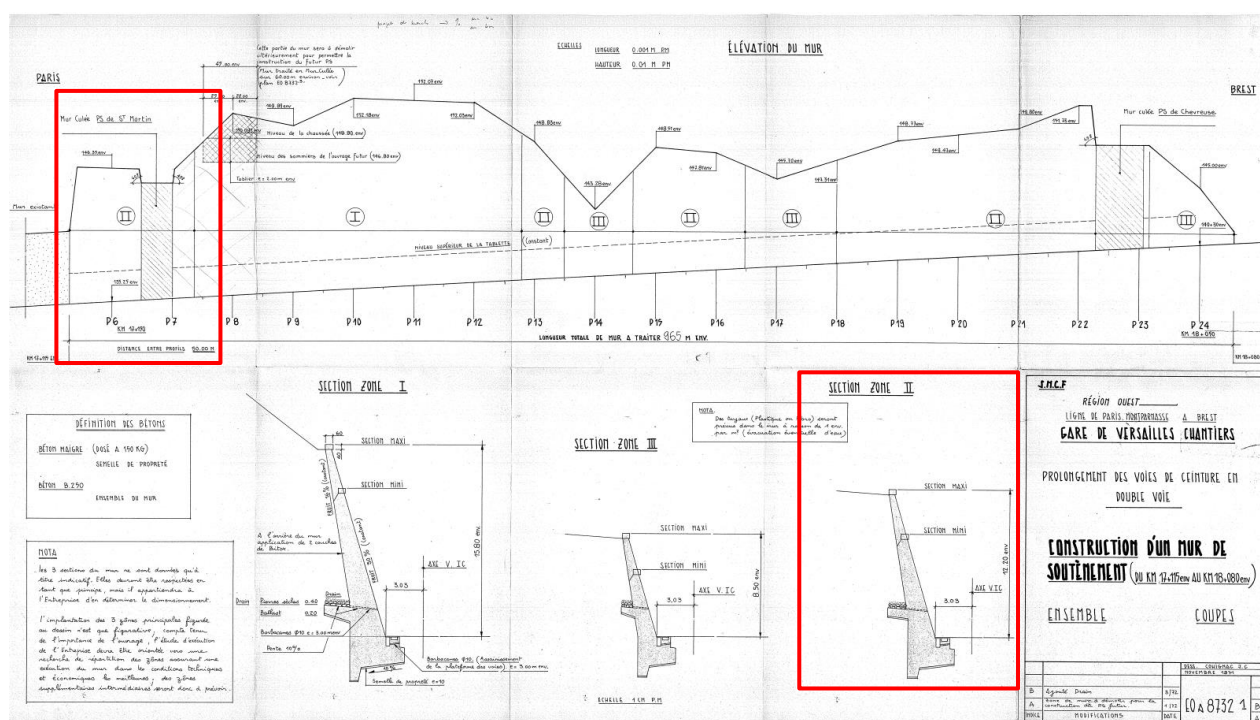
Plan et coupe de l'ouvrage de soutènement (Construction d'un mur de soutènement, ensemble coupes, 03/1972, indice B)
